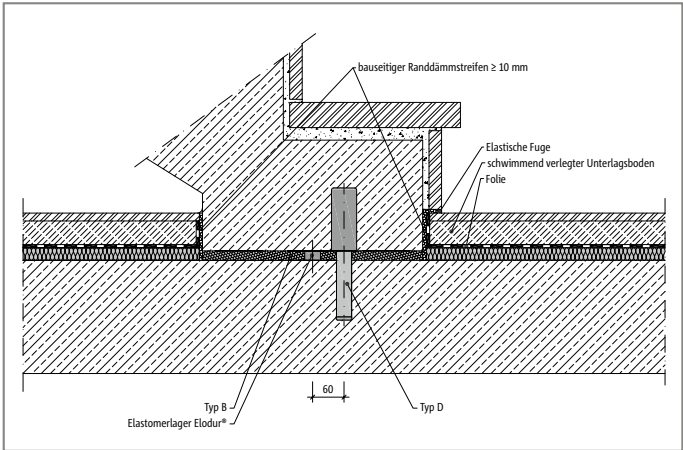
Schöck Tronsole® Typ B + Typ D: Einbausschnitt
